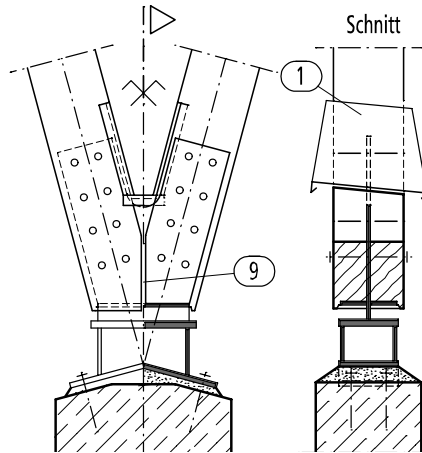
Strebenfuß mit schräger Blechabdeckung
